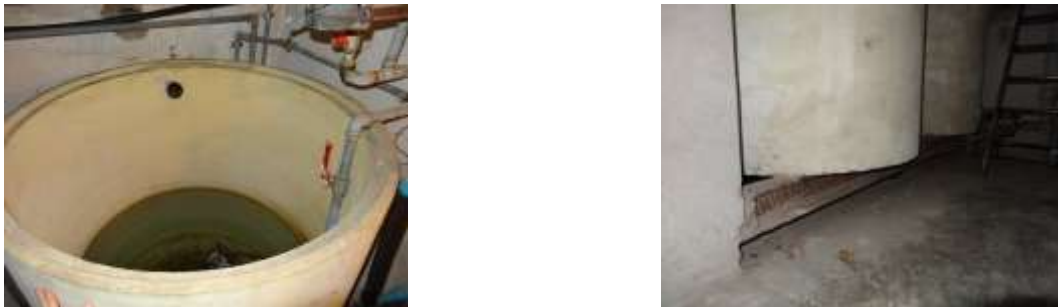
Serbatoi di accumulo dell'acqua al piano quinto.
